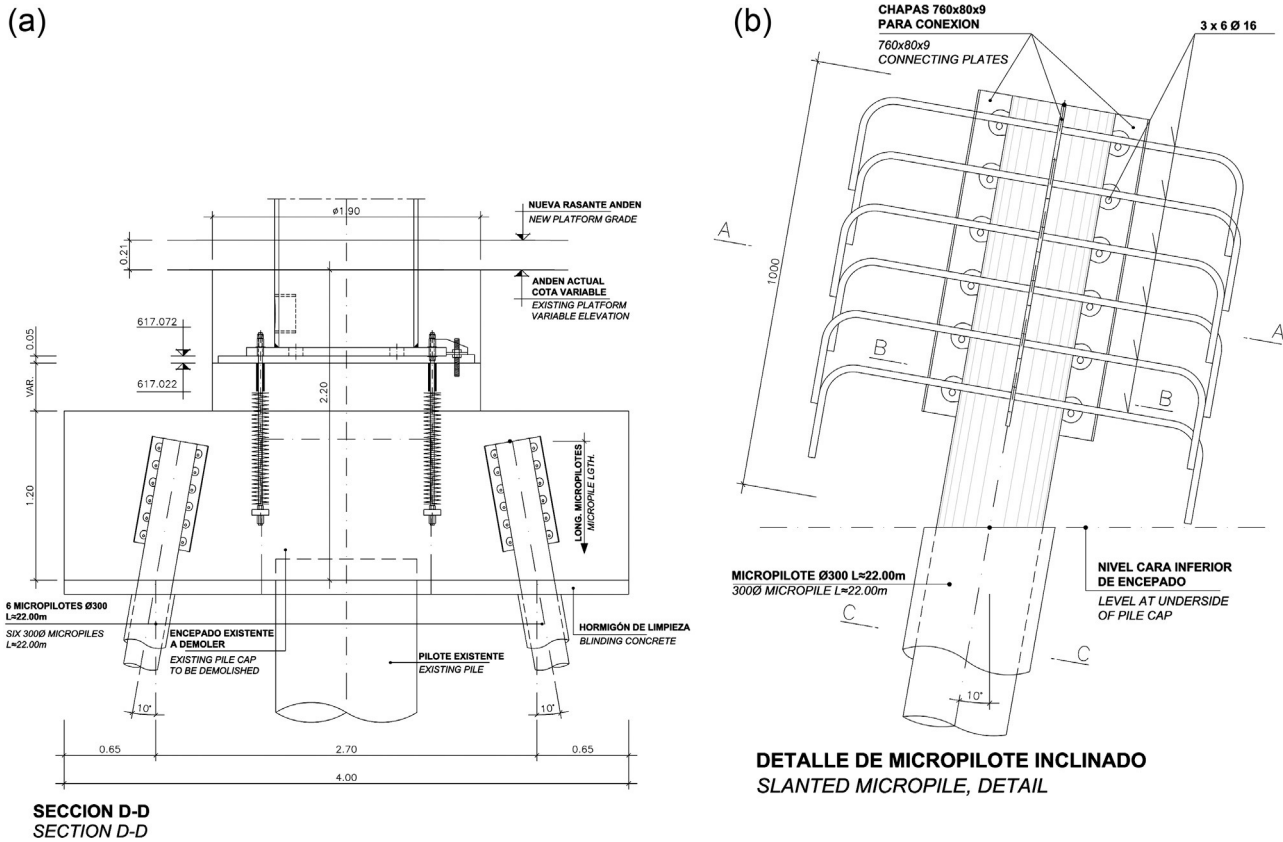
Encepado de la cubierta baja norte con detalle de conexión del micropilote.
